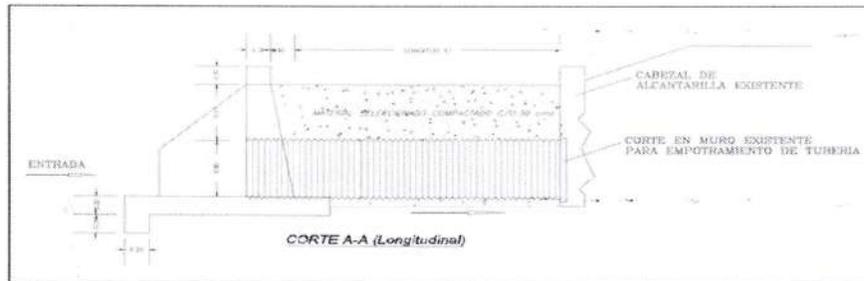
Perfil de las alcantarillas para prolongación. Fuente: TRANSFERPORT S.A.S.
